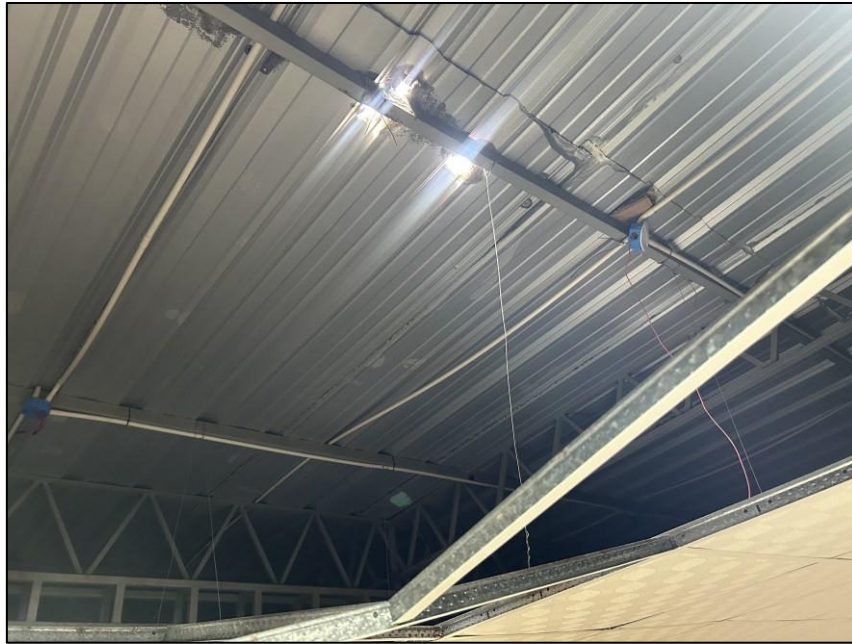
Se muestra el avance del daño en la cobertura liviana metálica tipo TR4 y la viga metálica de soporte.
